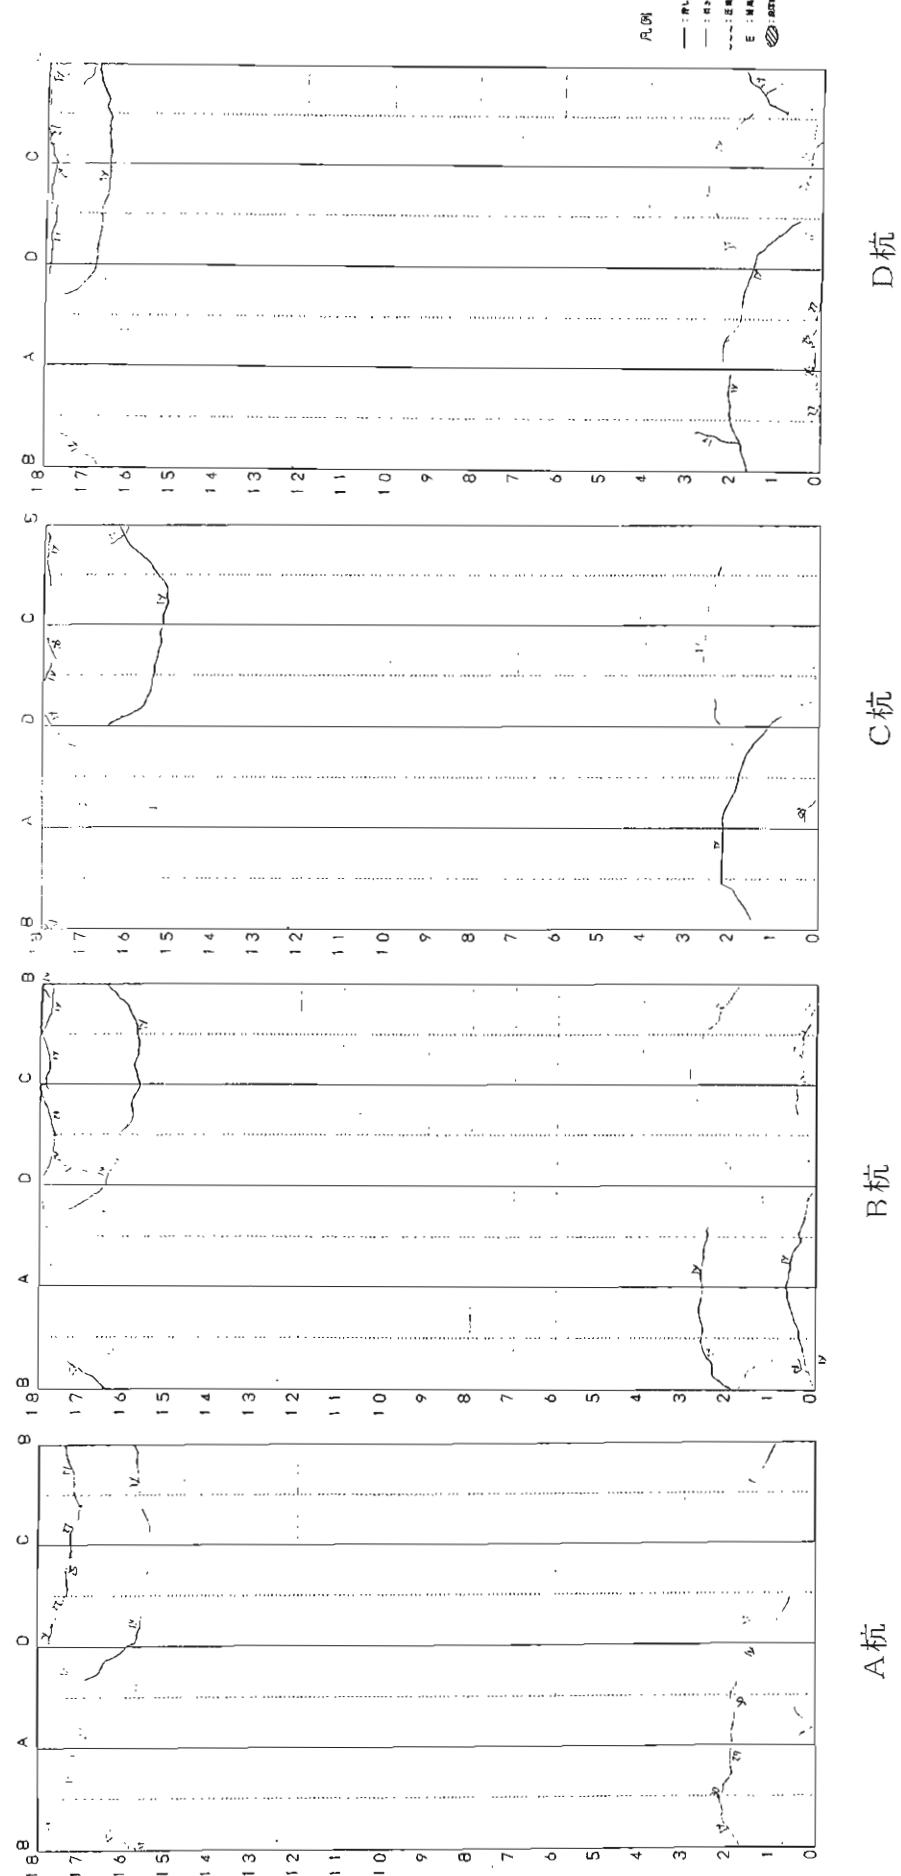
5. 10 桁体のひび割れ状況展開図 (ケース10、3δy)
